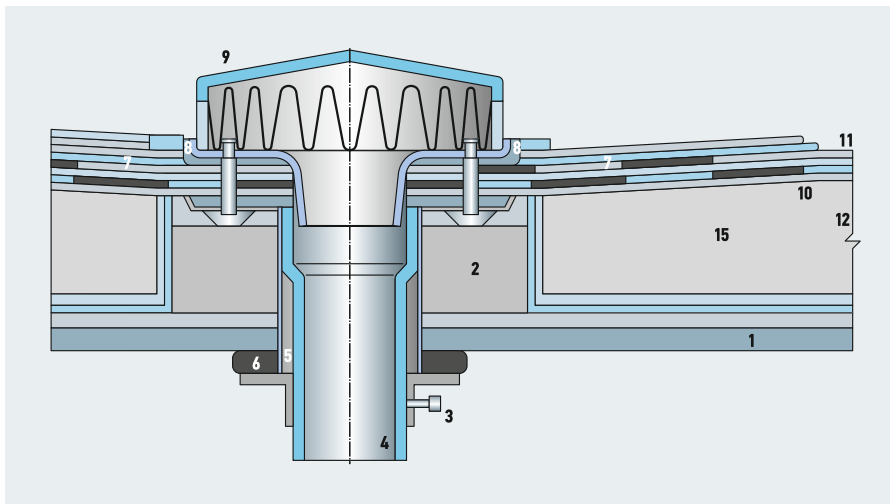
Размещение водосборной воронки в конструкции крыши [1 — железобетонная плита; 2 — опора; 3 — хомут; 4 — патрубок с фланцем; 5 — стекловата; 6 — уплотнитель; 7 — дополнительные слои ковра; 8 — мастика; 9 — колпак; 10 — местное понижение; 11 — основной водоизоляционный ковер из битумных и битумно-полимерных материалов; 12 — теплоизоляция (выкопировка из [3])]
